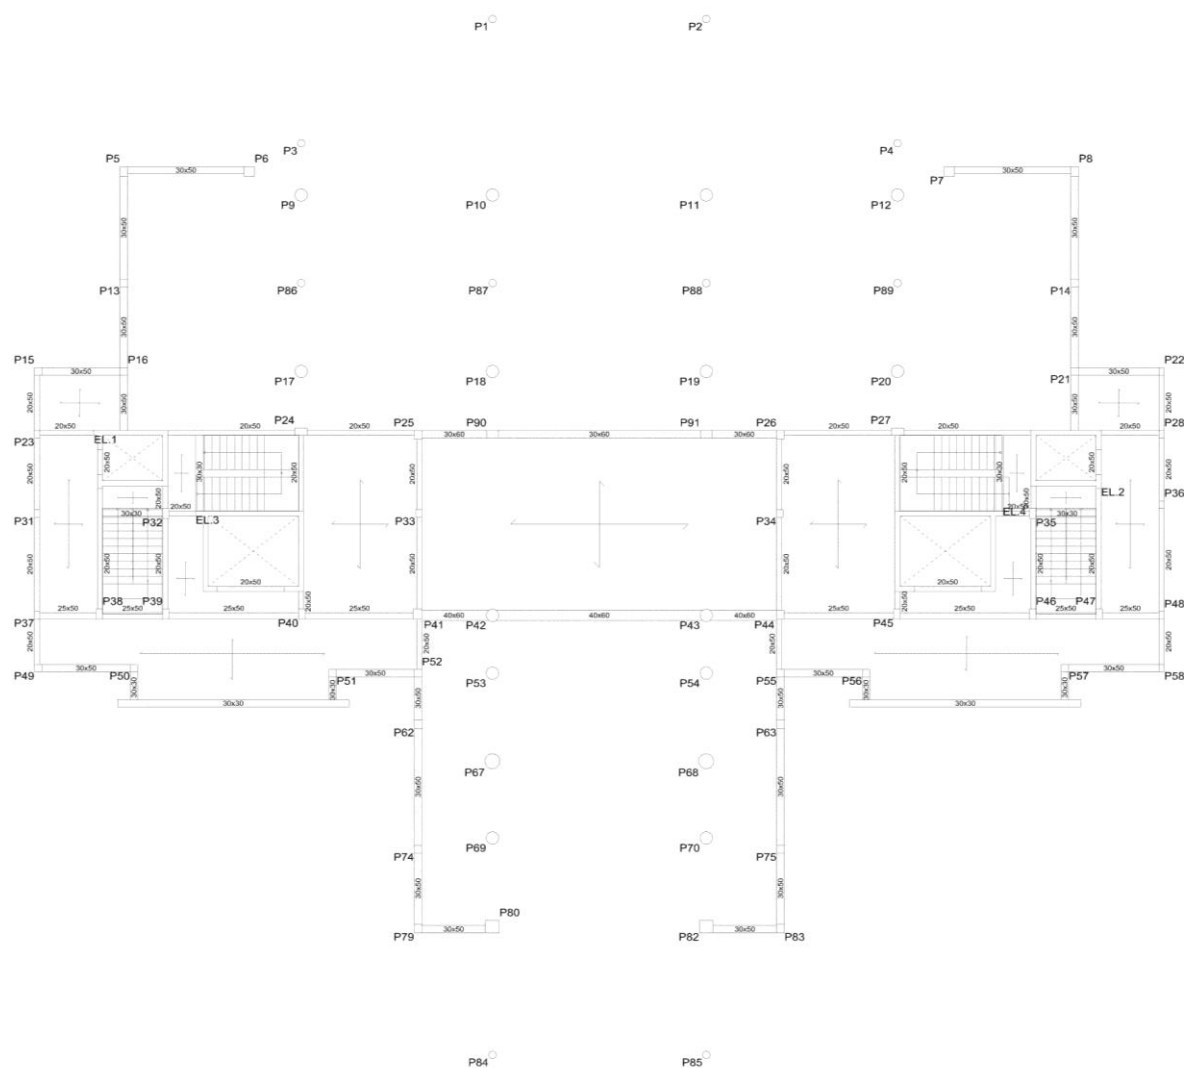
Planta estrutural do Piso 1: corpo E (s/escala).
